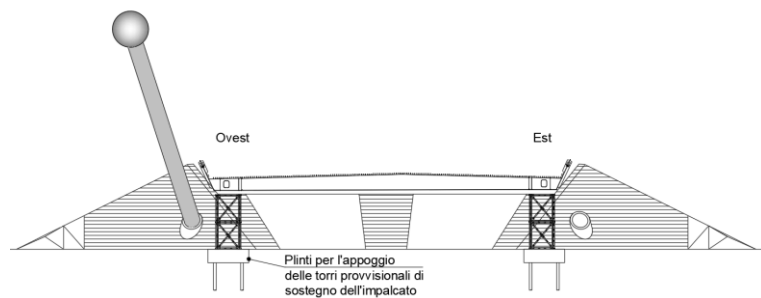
Impalcato appoggiato sulle pile provvisoriale e sulle spalle
